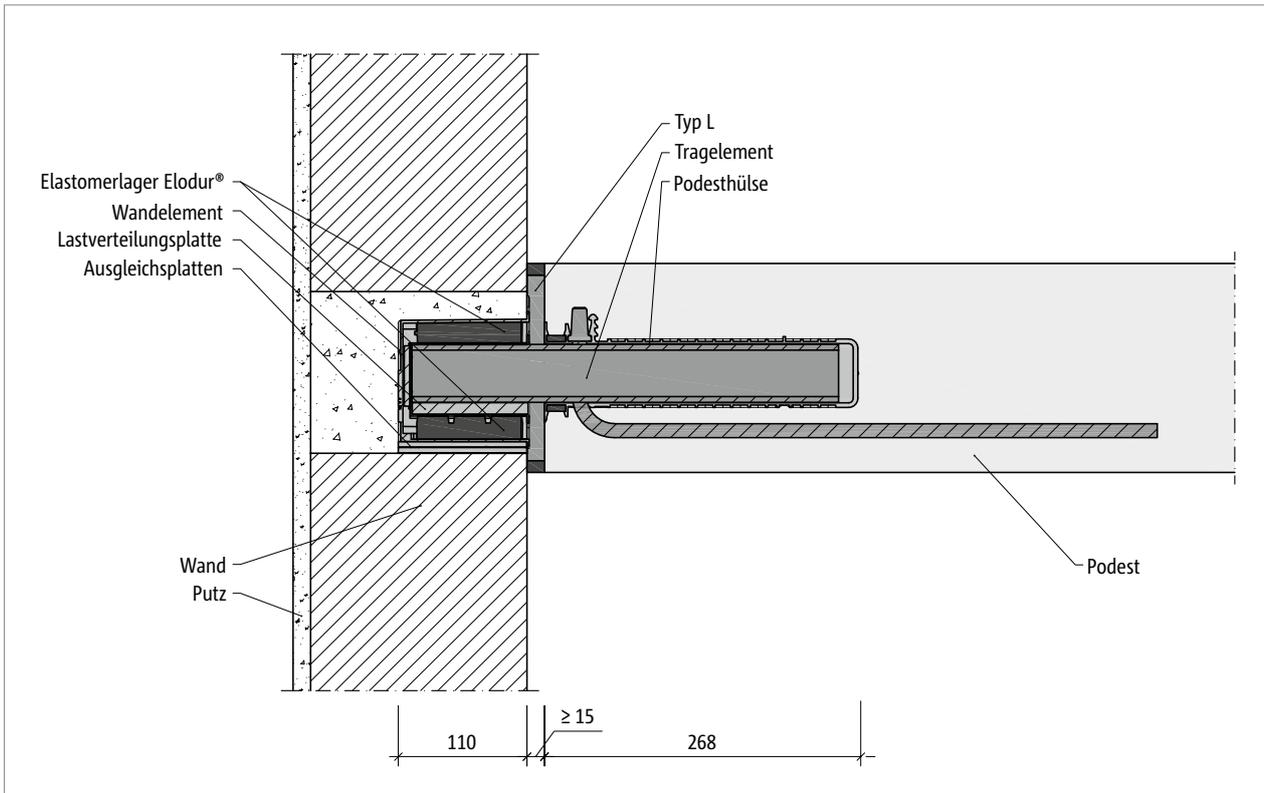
Schöck Tronsole® Typ P: Einbauschnitt mit Fertigteilpodest und Tronsole® Typ L
